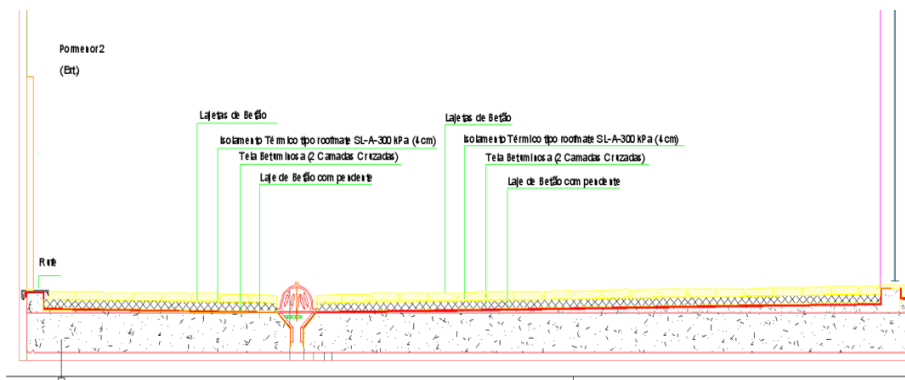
Solução Construtiva: Cobertura e Parede Exterior-ETIC`S)
